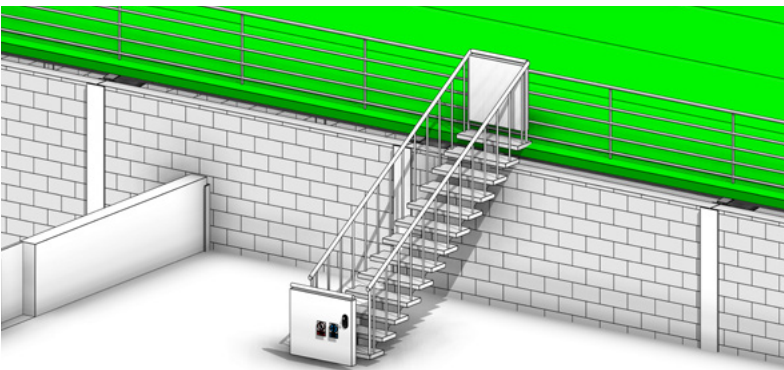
Escalera de acceso entre las cubiertas de la nueva nave y la existente y puerta de acceso con cierre y apertura remoto
